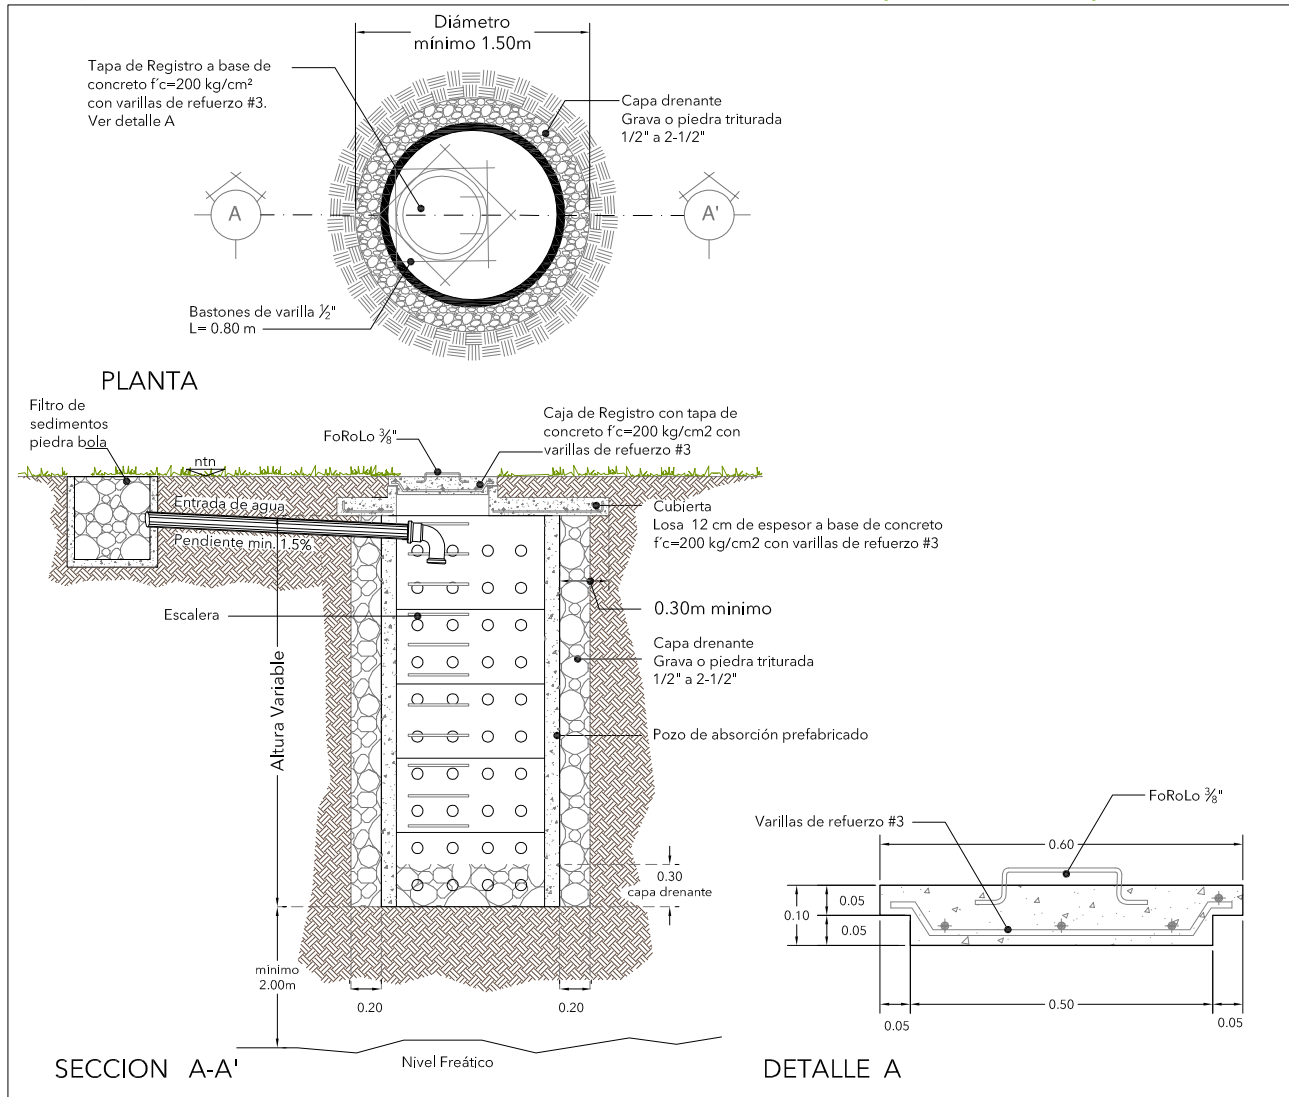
Detalles constructivos de Pozo de Infiltración con muros de mampostería (concreto prefabricado)
